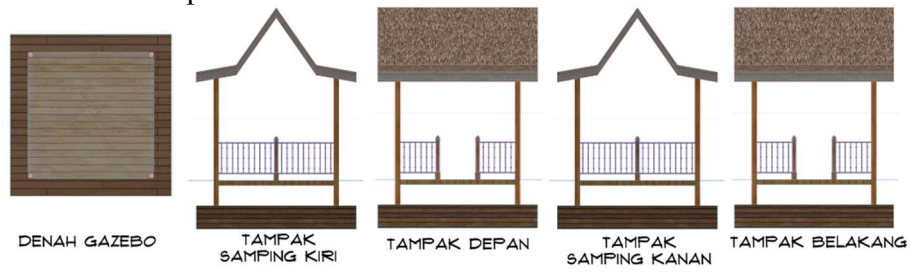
Prototipe Bangunan Komersil Tipe B
